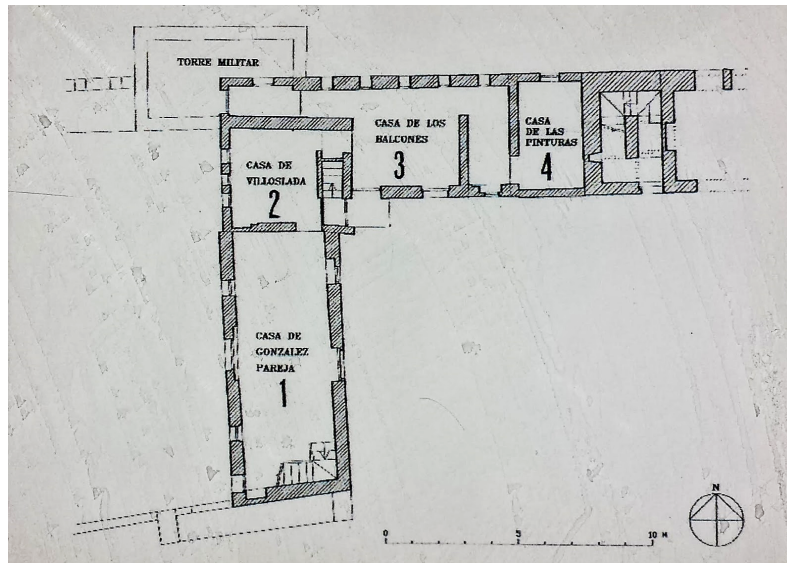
Casas del Partal. Planta baja. Estado actual (A. Orihuela Uzal)
